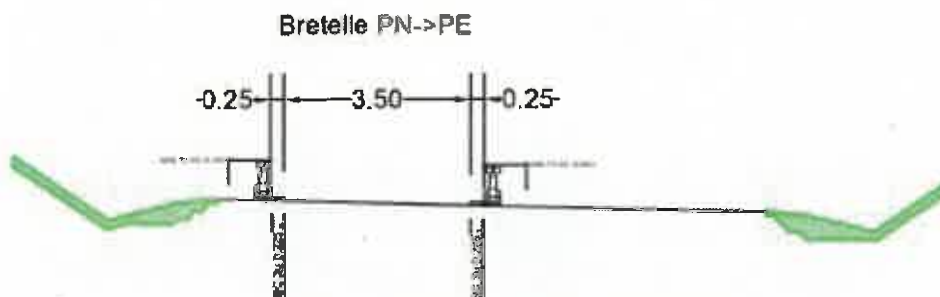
Profil type réduit sur bretelle PN->PE définitive
